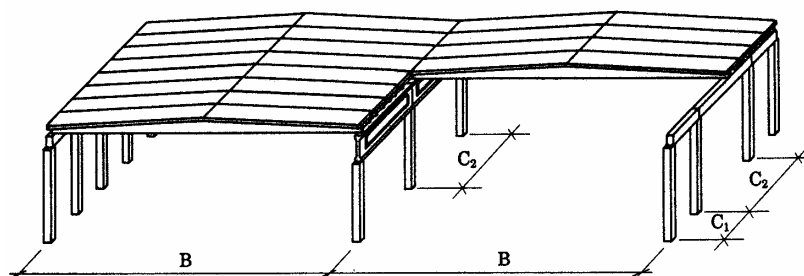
Elementos de laje em duplo "T", com duplo caimento para telhado duas águas, apoiados em traves planas longitudinais.
